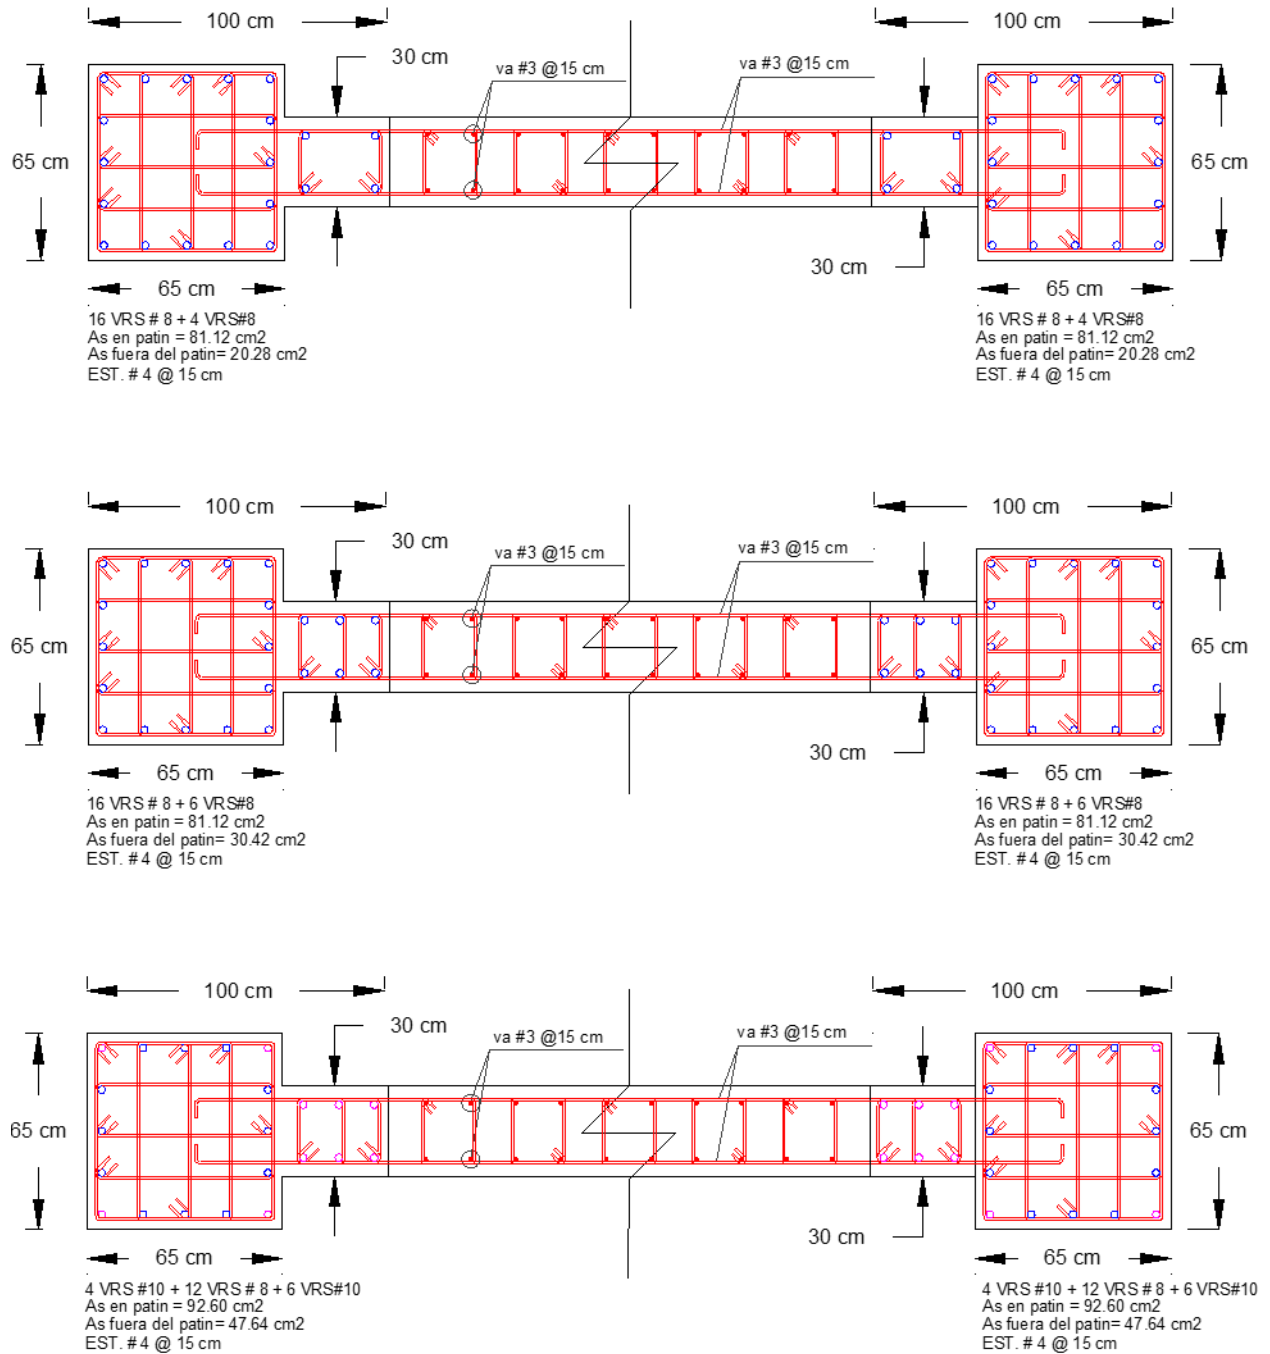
Detallado del refuerzo en los muros de muros del sistema dual.
